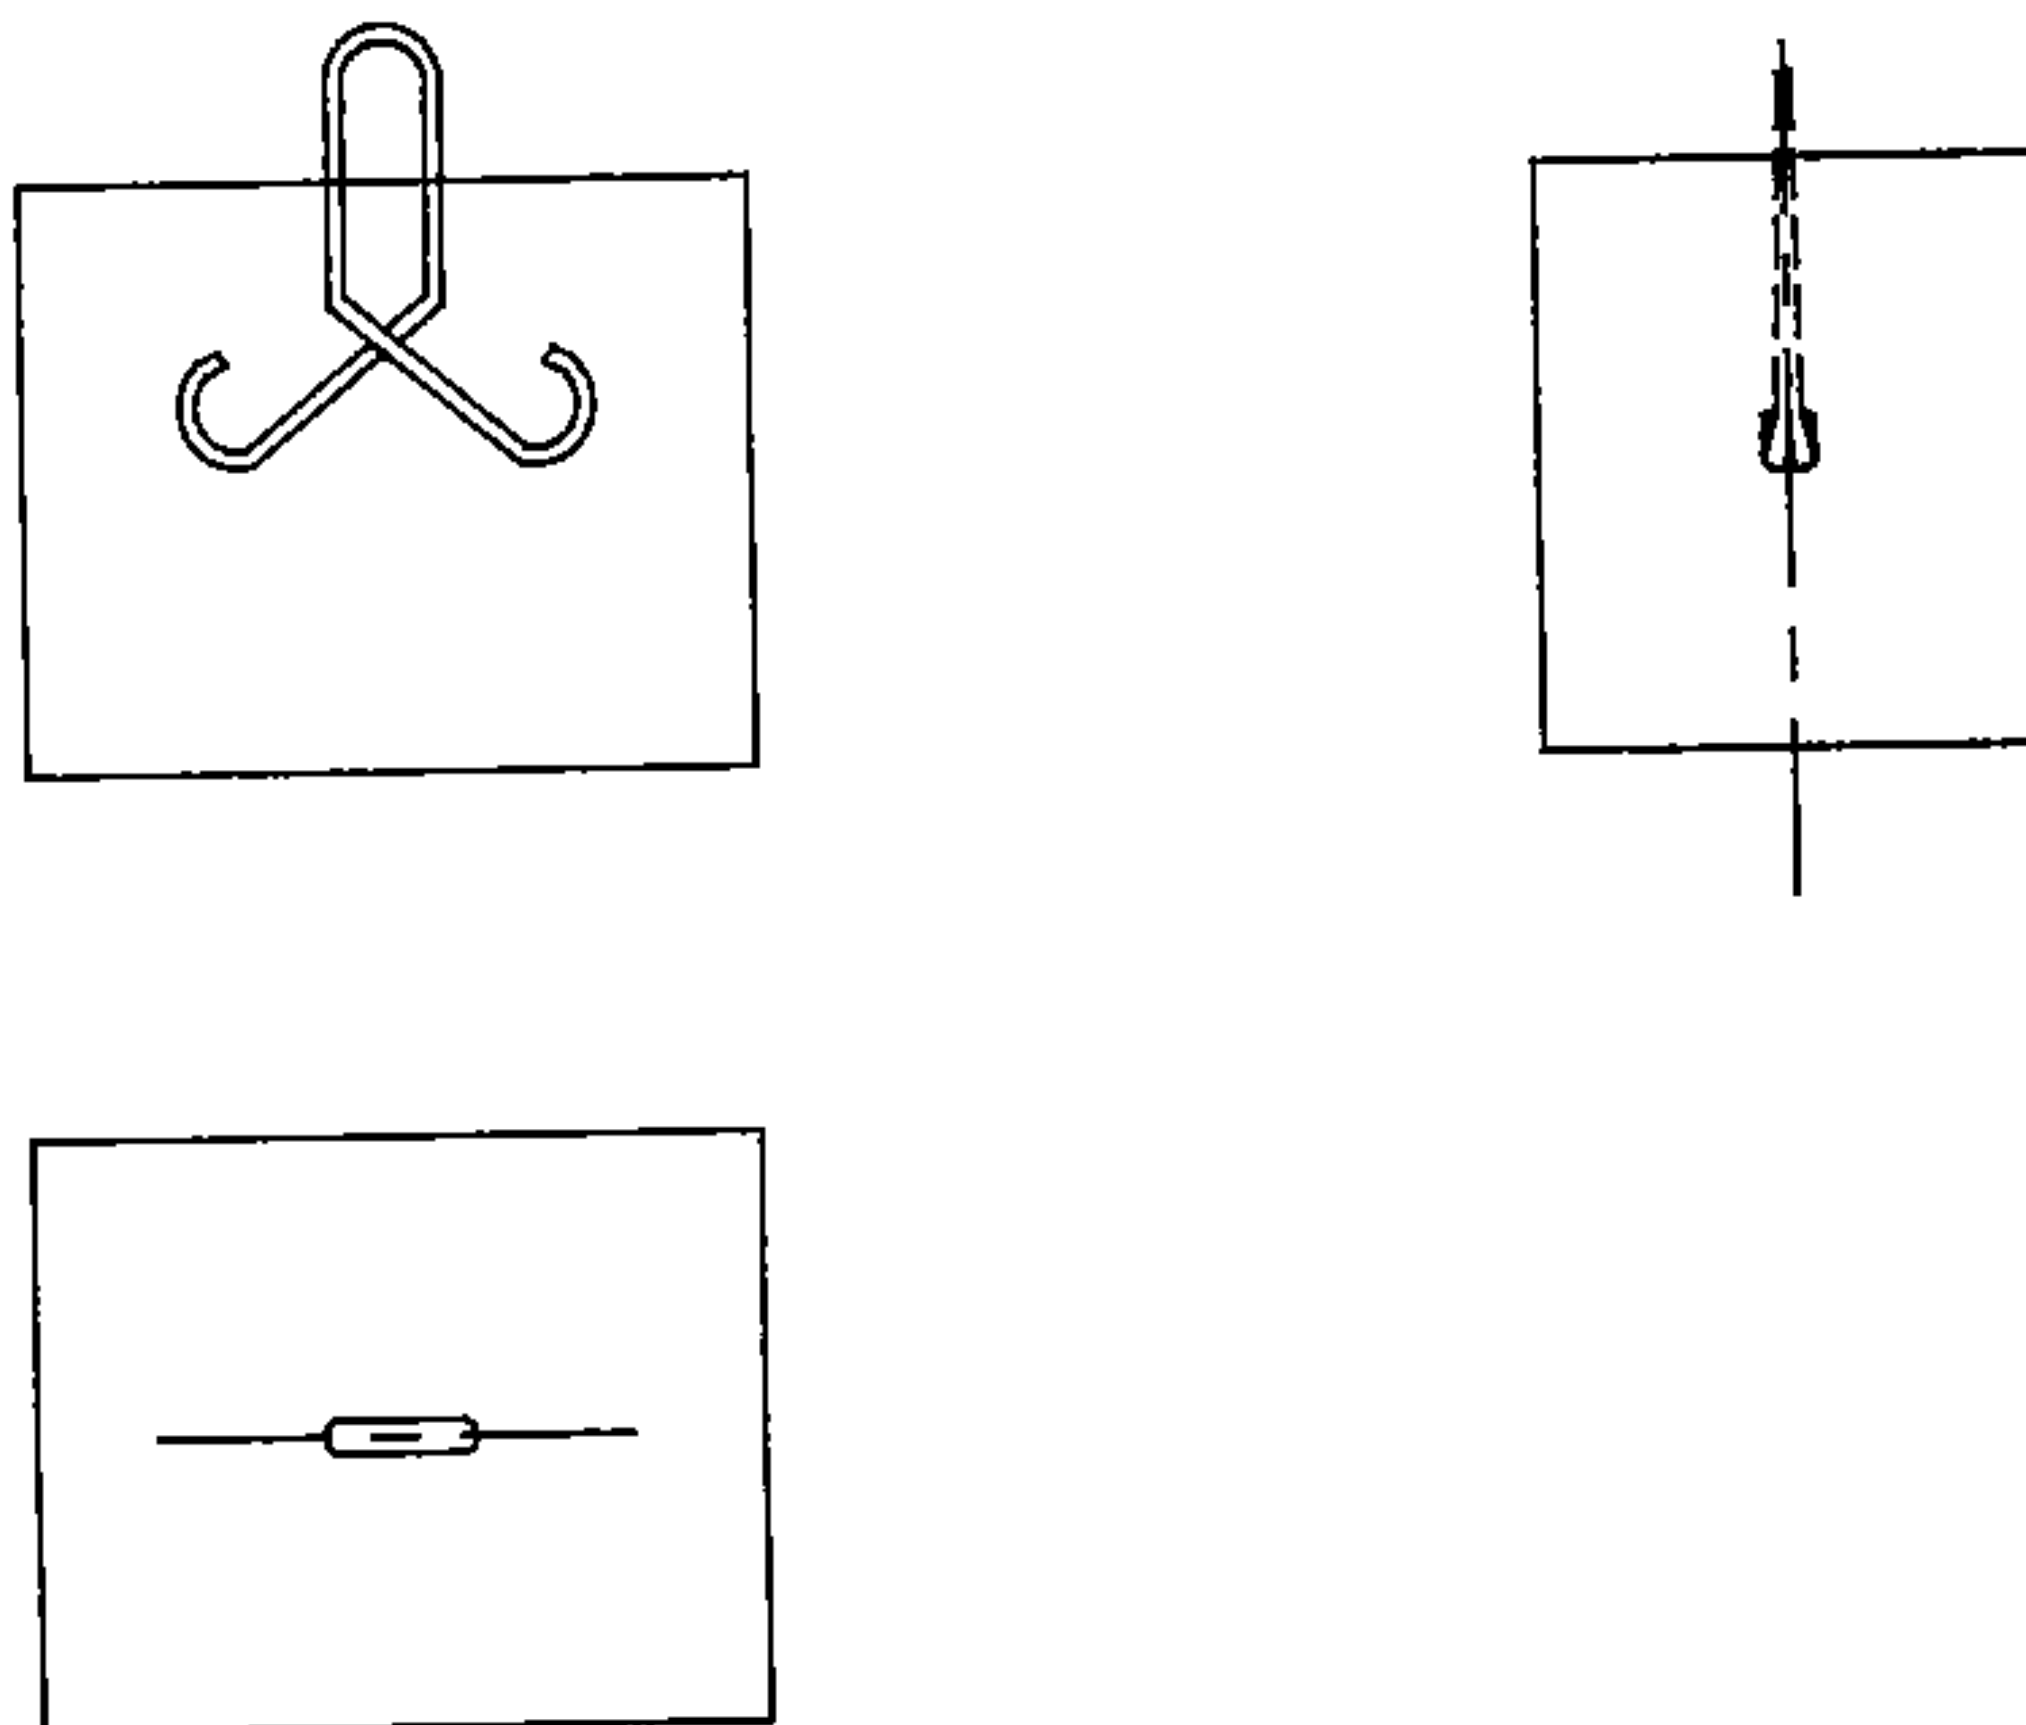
浮碼頭錨錠混凝土方塊設計例
